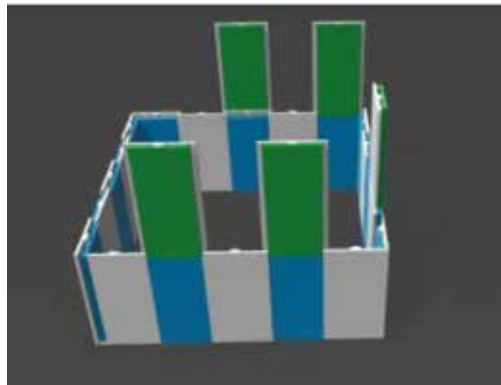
Propuesta de ensamblaje en vivienda modular. Fuente: Romero y Laguna (2017)
